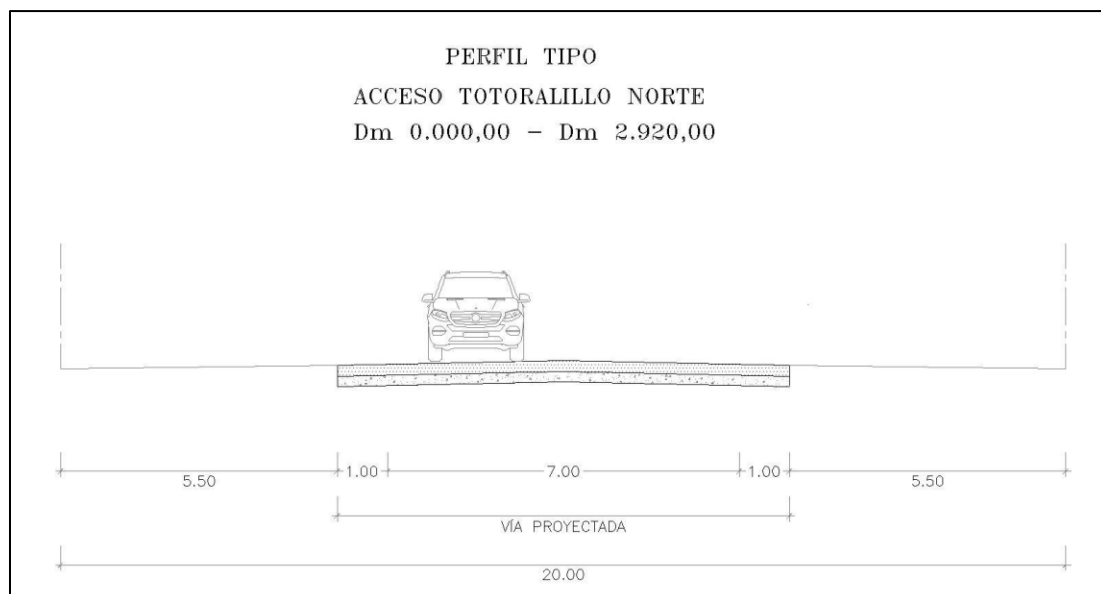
Perfil Tipo Situación Con Proyecto.
